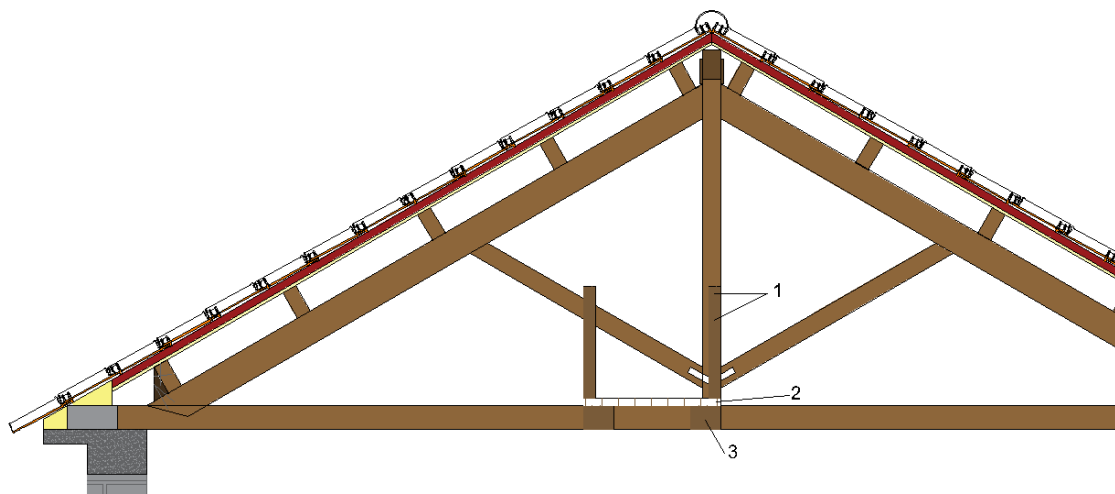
Planta da cobertura com passadiço em madeira.
